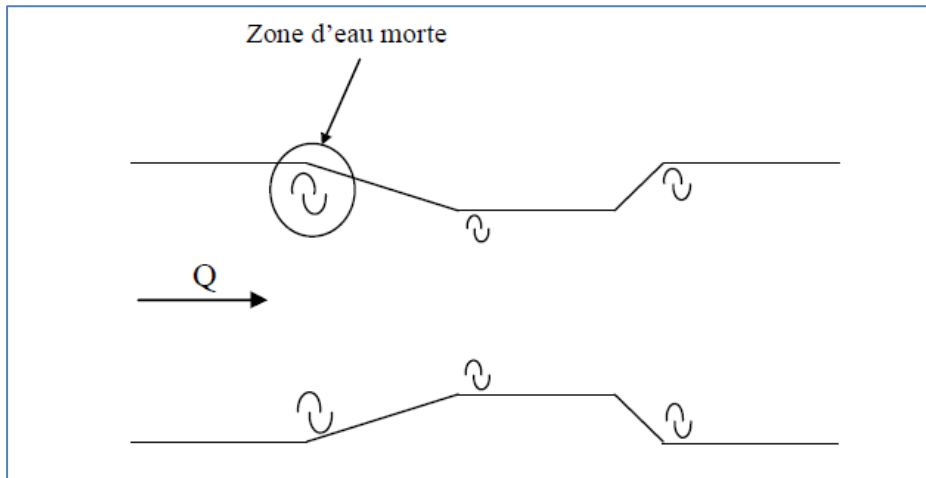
Vue en plan d'un canal jaugeur de section rectangulaire avec apparition des zones d'eau morte
